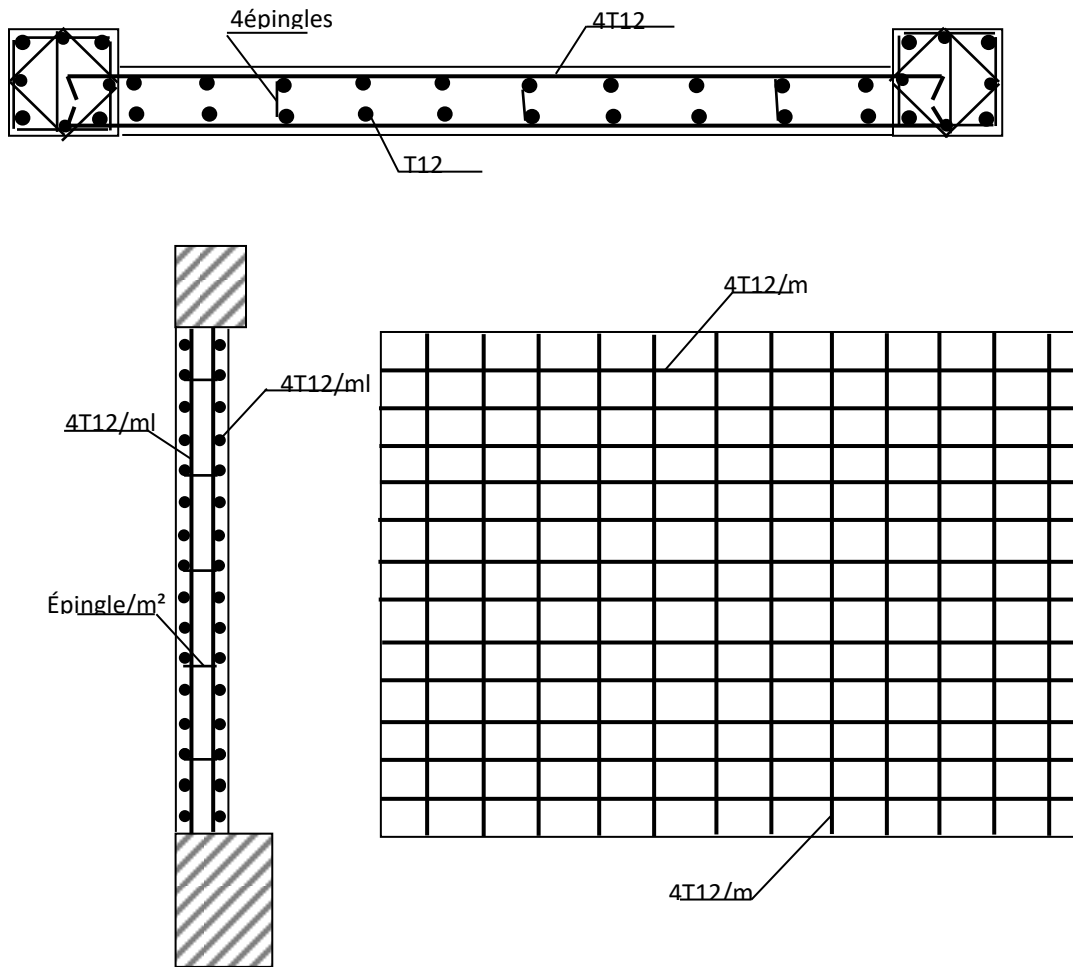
Schéma de ferrailage de voile de contreventement.
